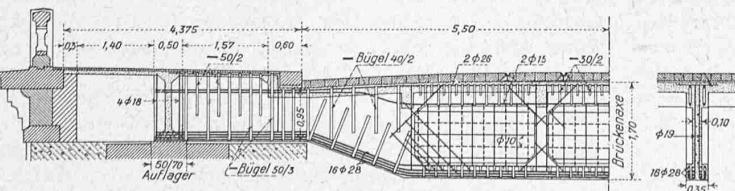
Fahrbahn-Querträger, Armierungsplan. Ansicht und Schnitt, 1:120.
